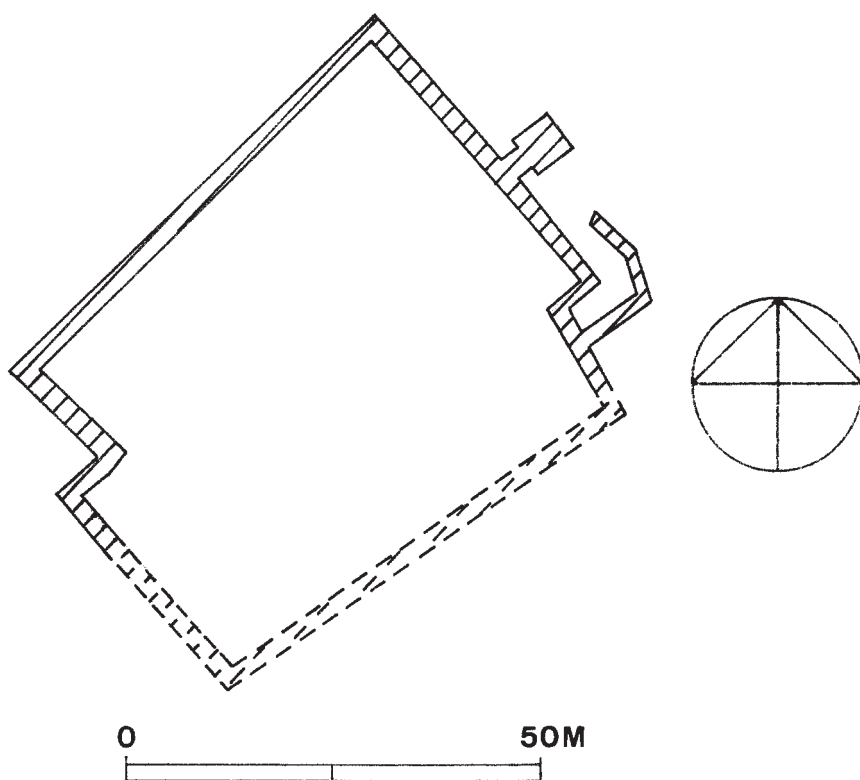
Planta do Castelo de Paderne (Albufeira).
